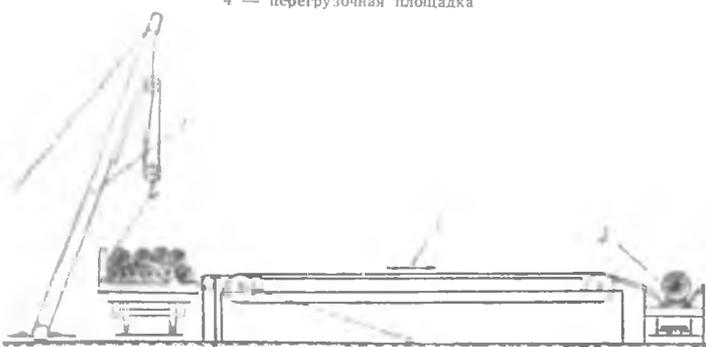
Схема перегрузочной площадки с поперечным транспортером:
